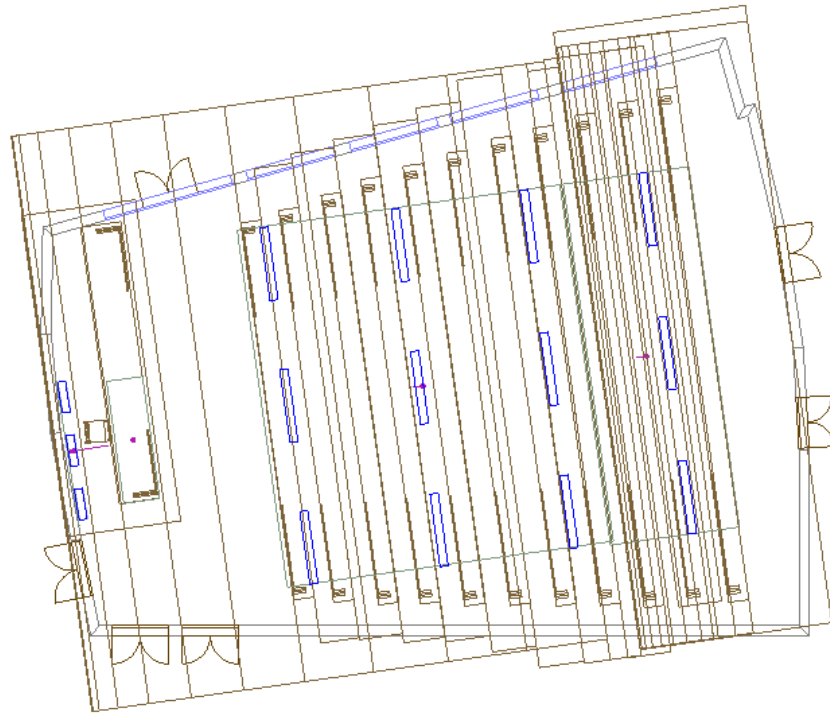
11: Aula 40 (Area 2 e Area 21) – Planimetria
